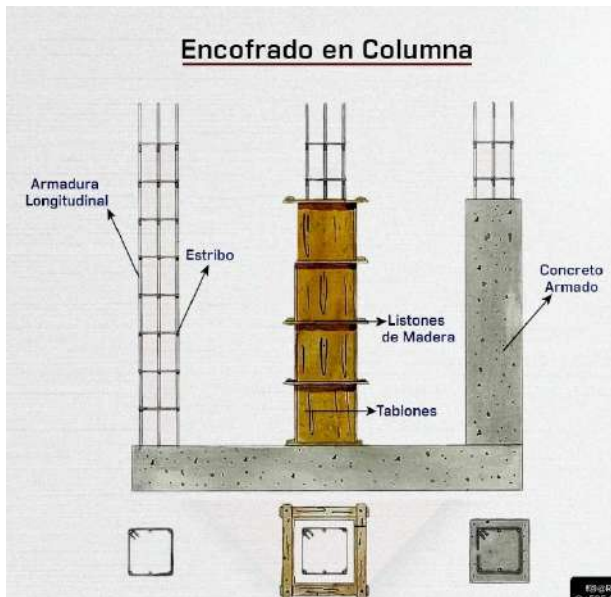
Proceso constructivo de una columna de hormigón. Fuente: R. MAIA, S.A. 2024
